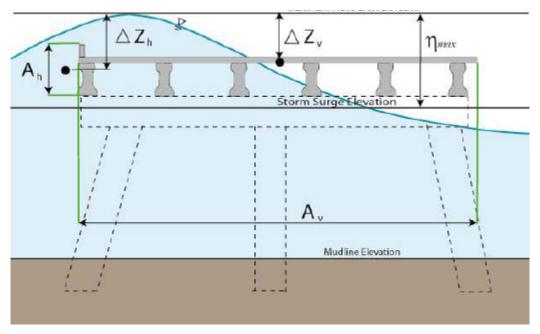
schema di calcolo per le componenti di sollecitazione dovuta alle onde.
